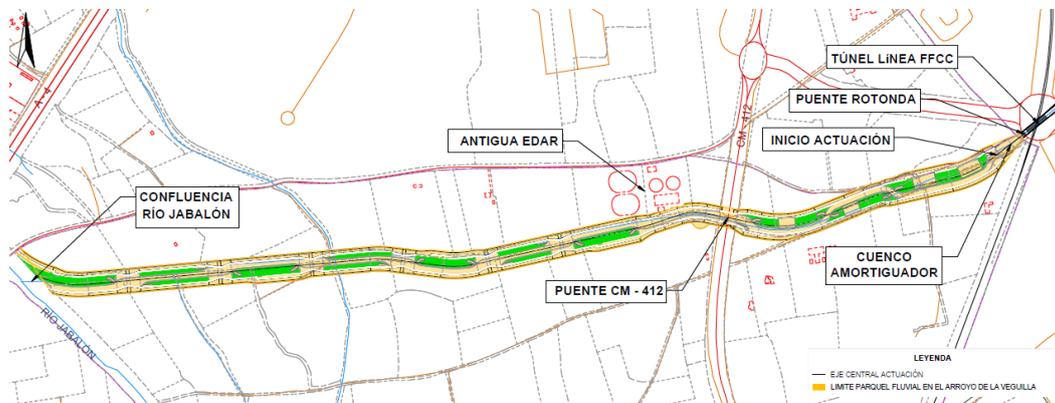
Planta del parque fluvial proyectado sobre el arroyo de la veguilla desde la salida del cuenco amortiguador, aguas abajo del FFCC, hasta la desembocadura con el río Jabalón.
